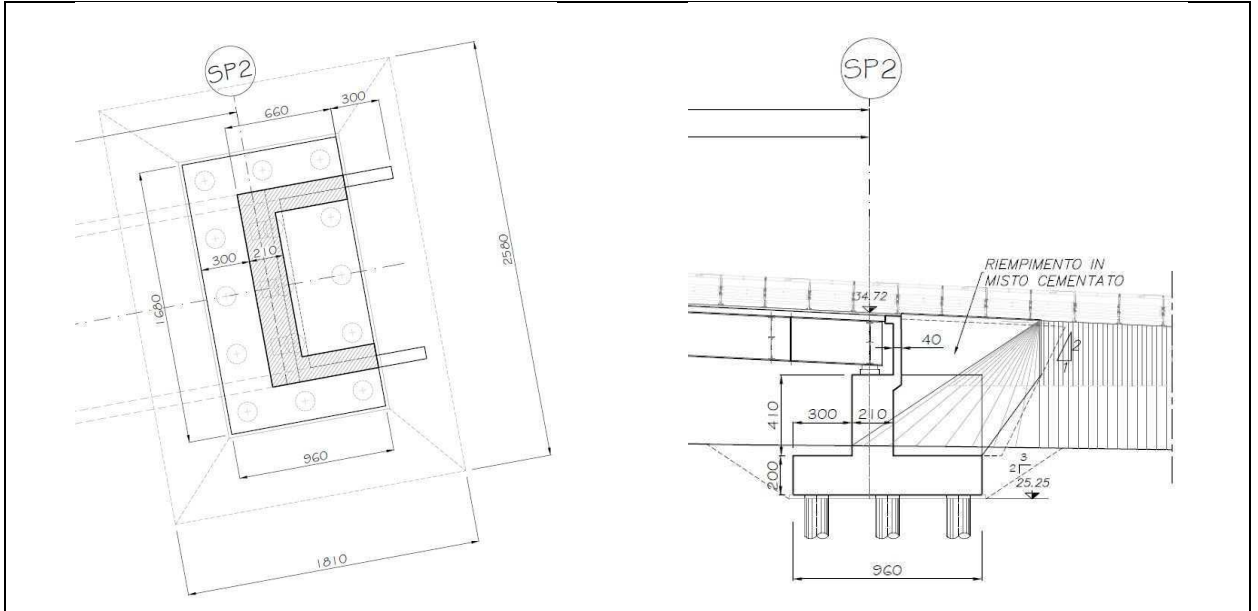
Spalla 2 – Pianta Fondazioni Sezione
